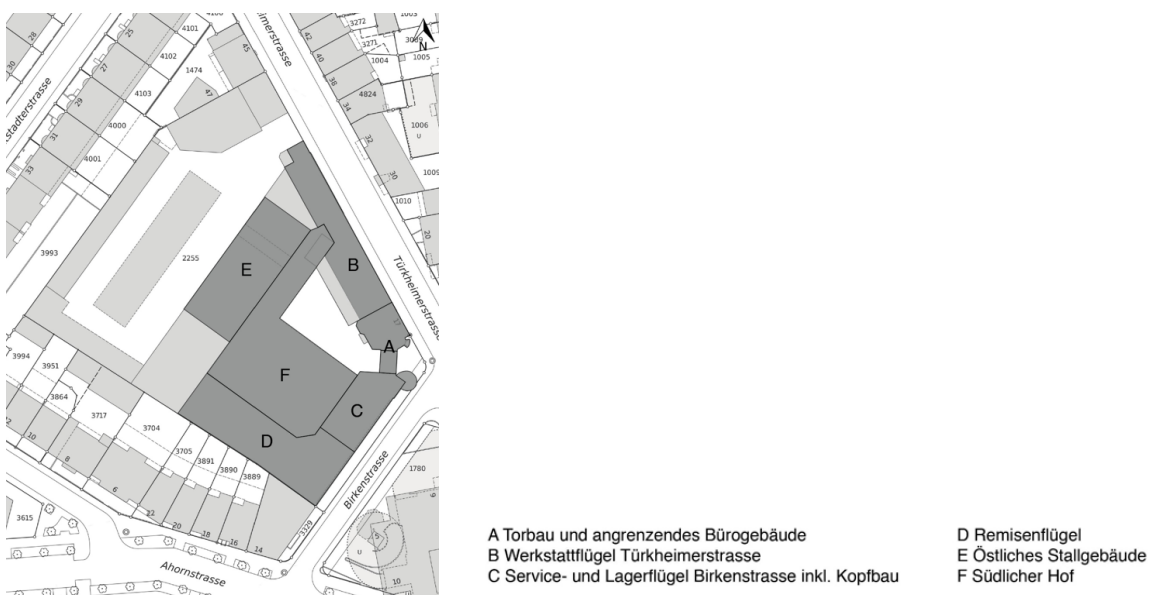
Plan zum Schutzvertrag zwischen Kantonaler Denkmalpflege und Grundeigentümerschaft (Plan genordet, kein Massstab)
